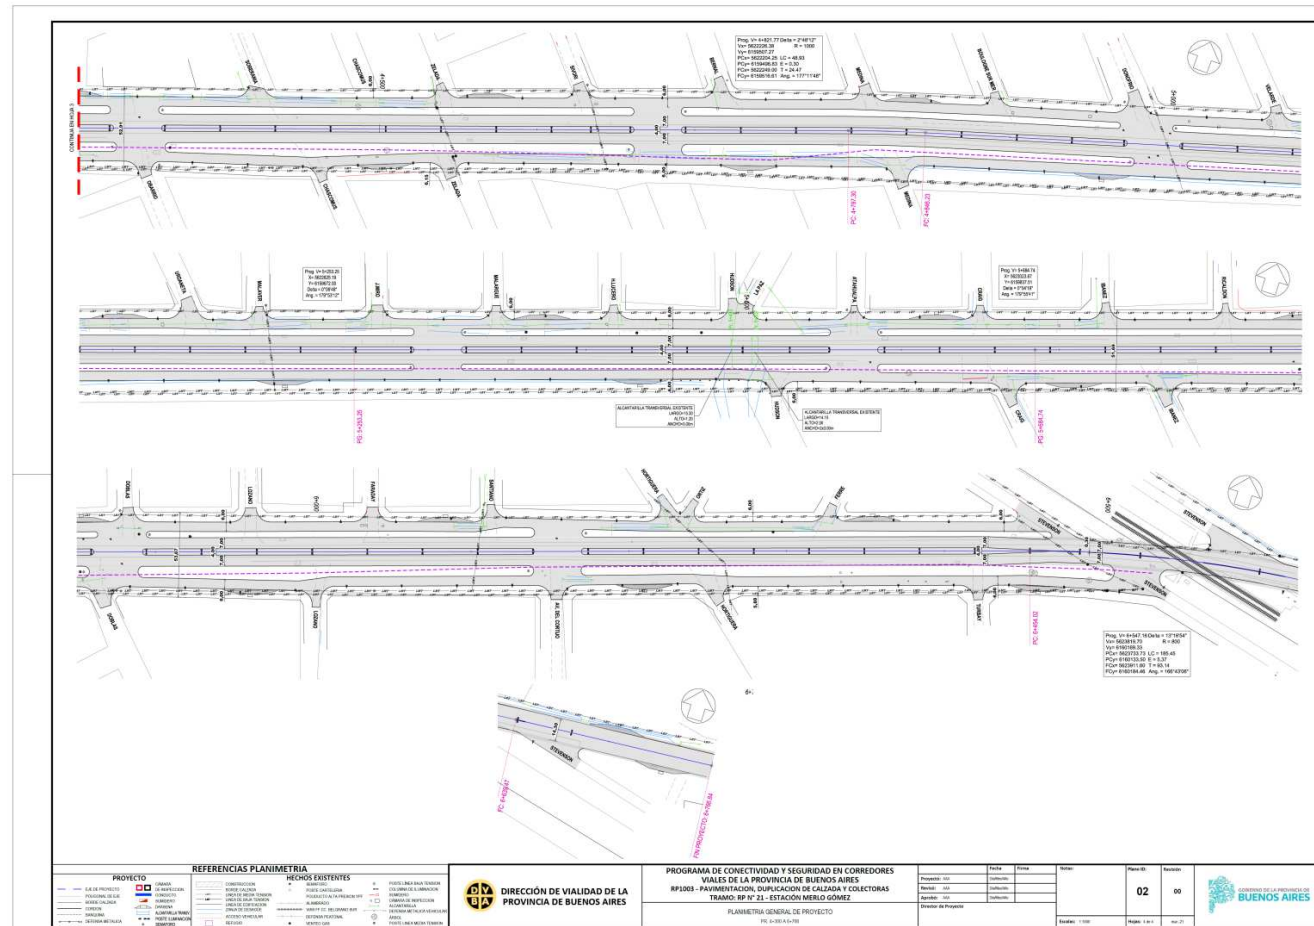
Planimetría general del proyecto, progresiva 4+300 a 6+7666
